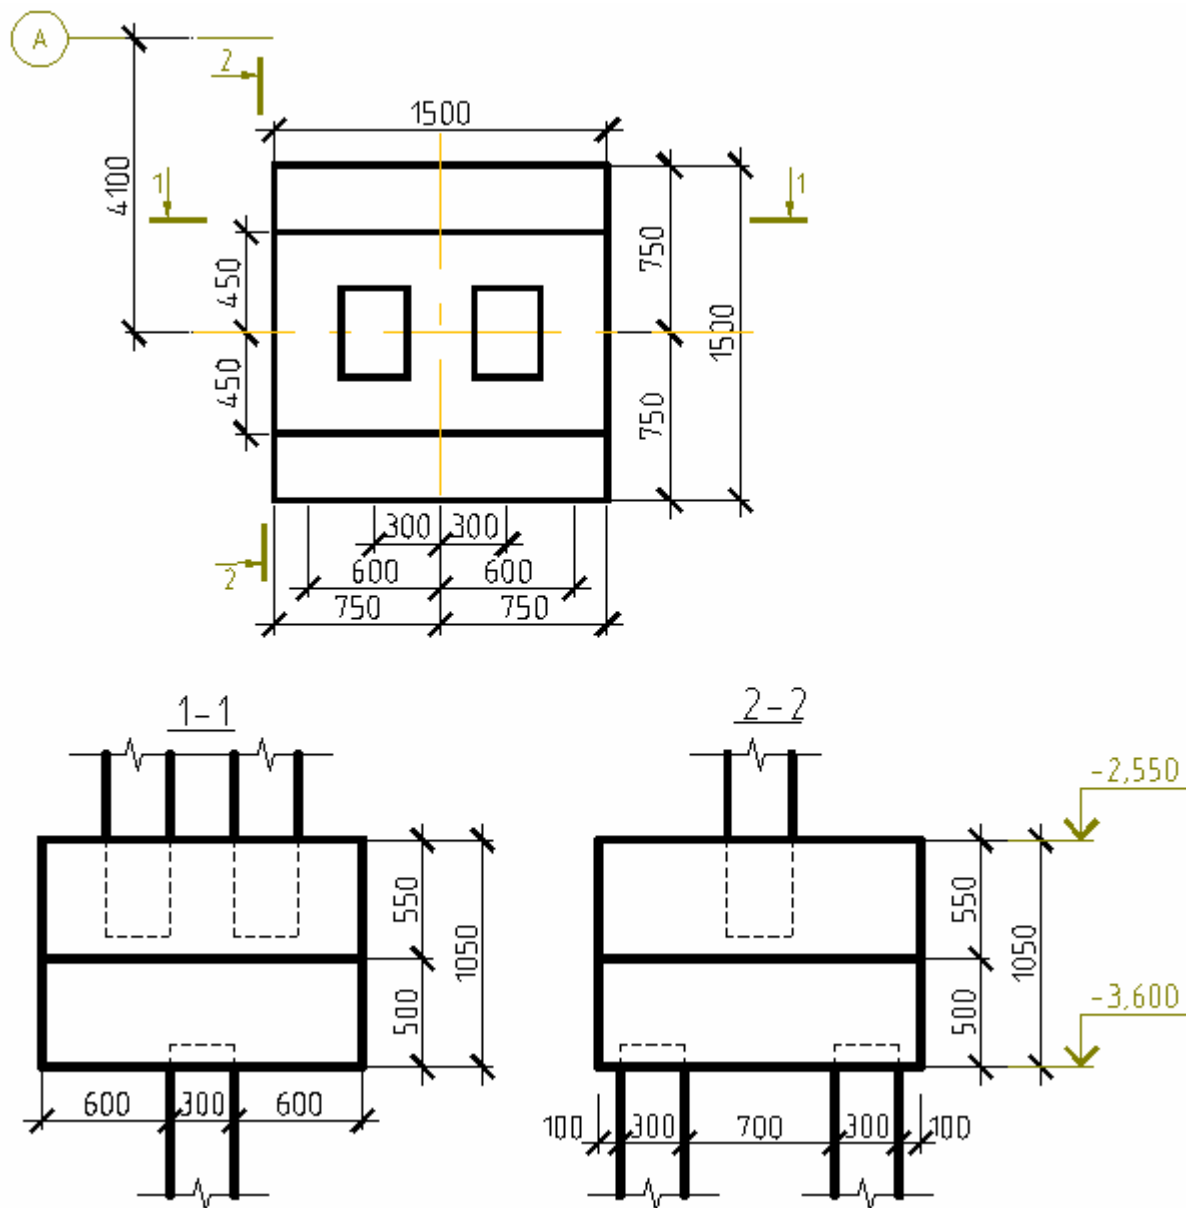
1. 5. Схема фундамента под колонны пандуса.
